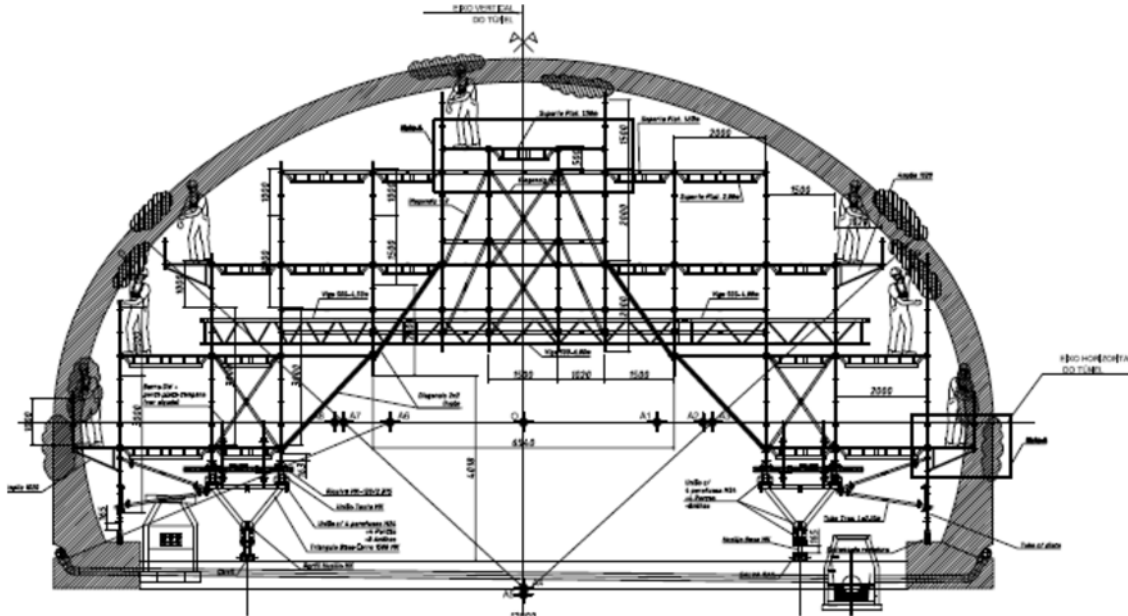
Secção tipo do carro de andaimes para montagem das armaduras
